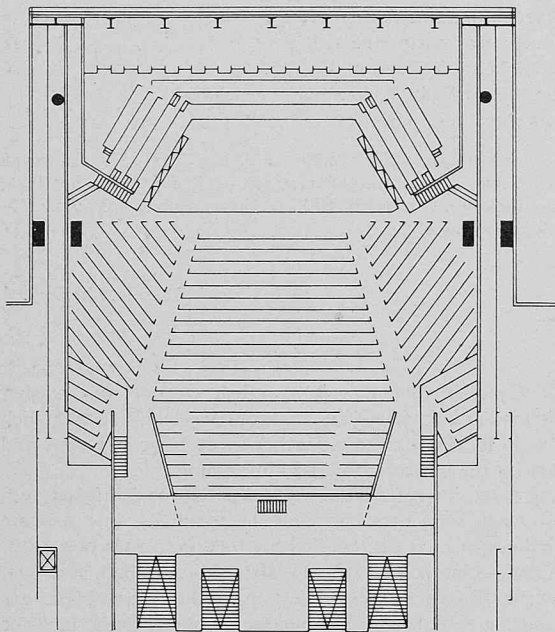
Grundriss und Platzanordnung im grossen Saal
